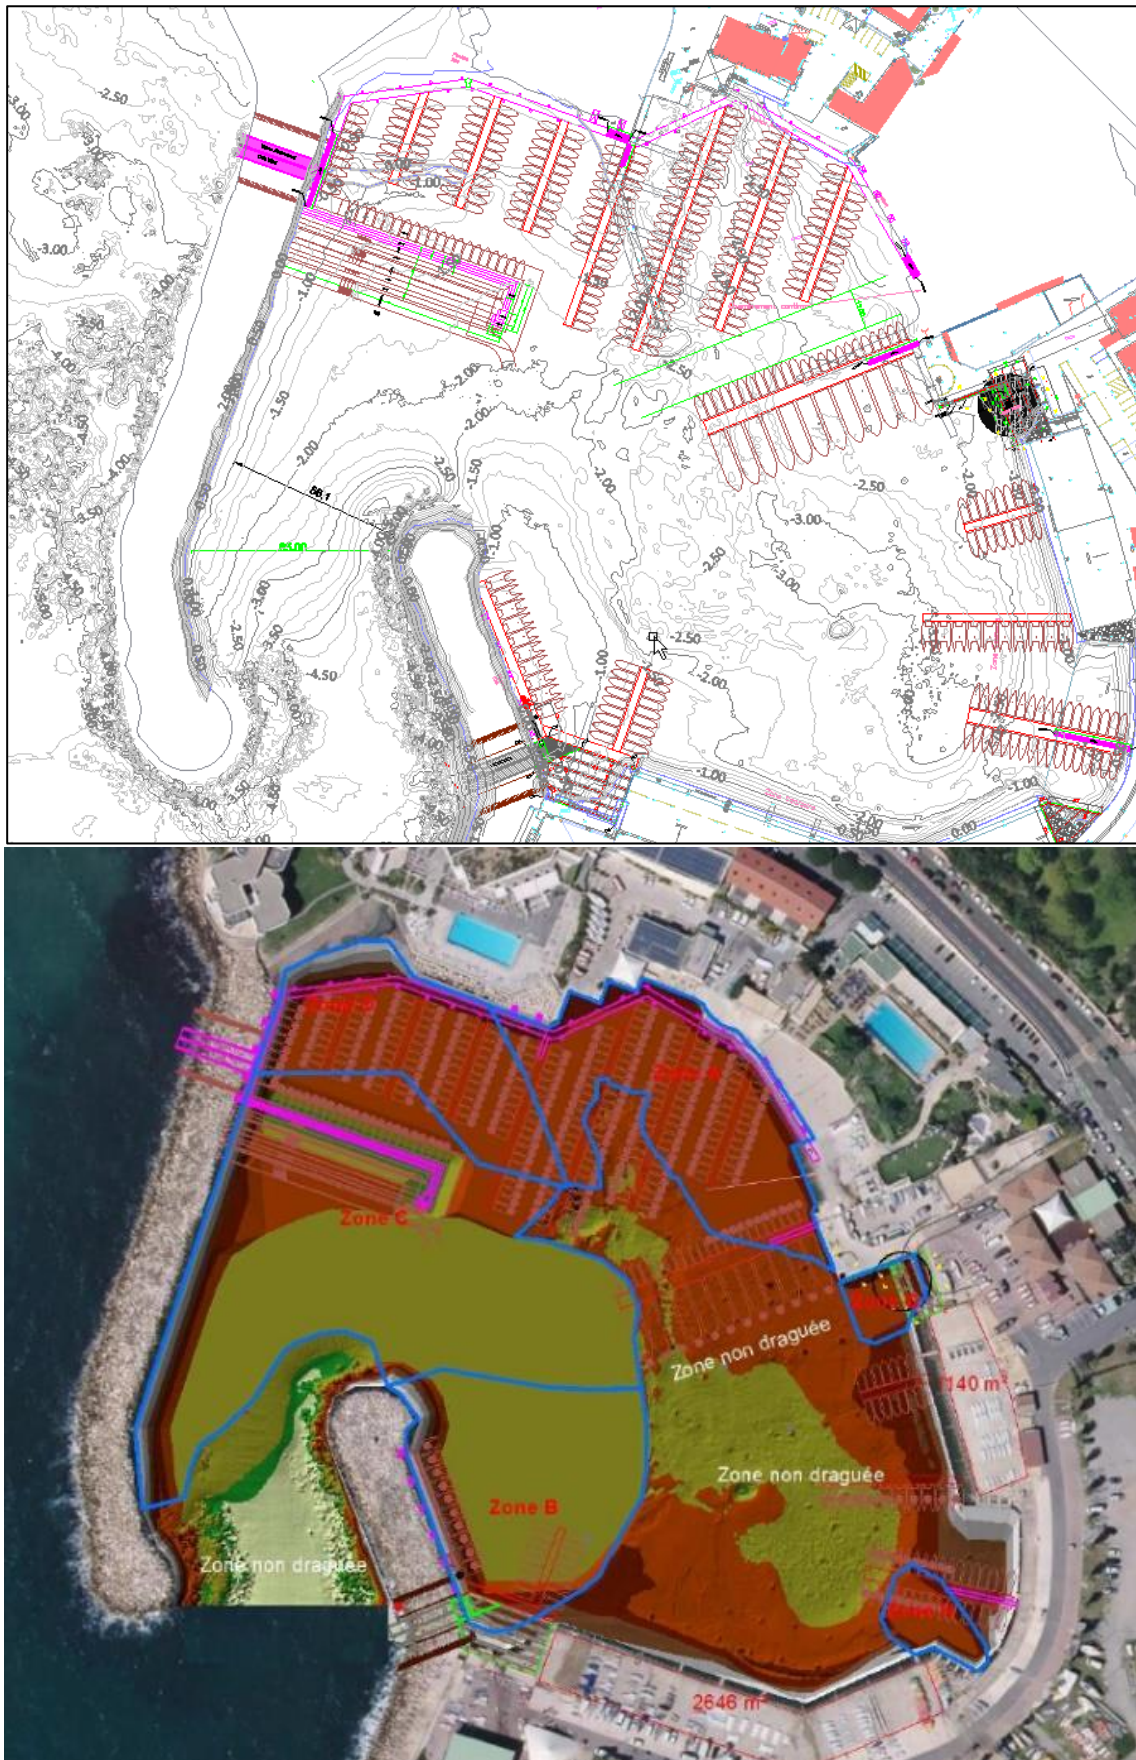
Projet d'aménagement – Plan masse et plan de dragage
